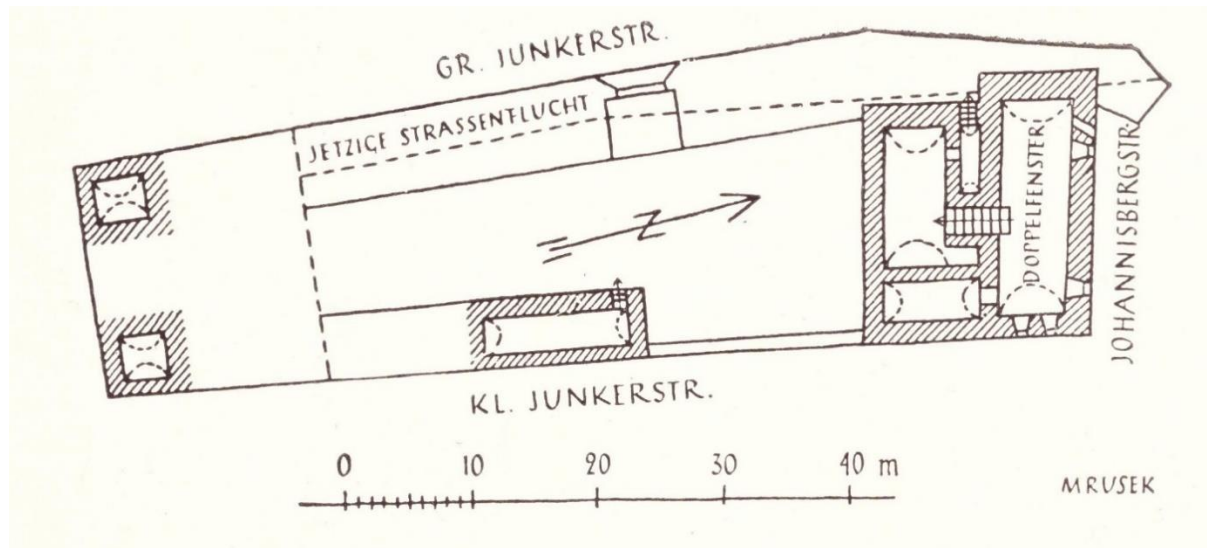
Magdeburger Altstadt – Grundriss des Festen Hofes Johannisbergstraße 3
